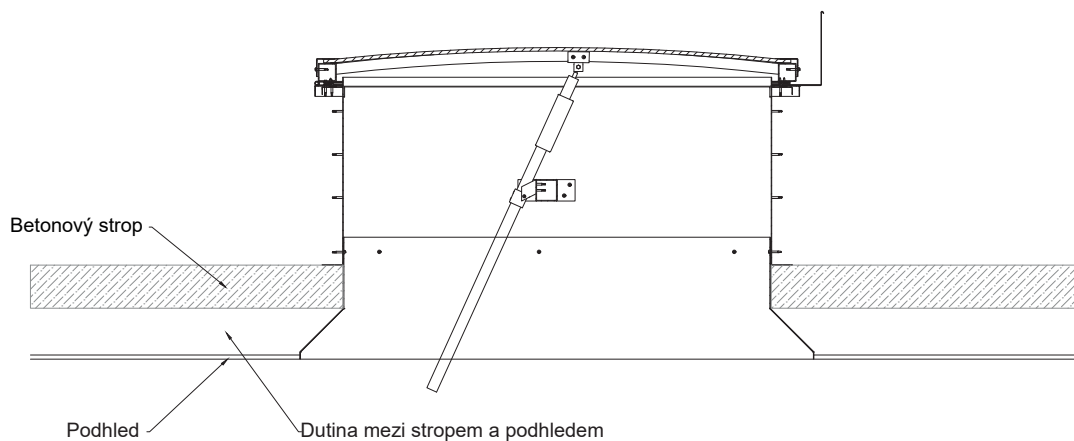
Průřez klapky s tepelnou izolací pro instalaci na betonový strop.
